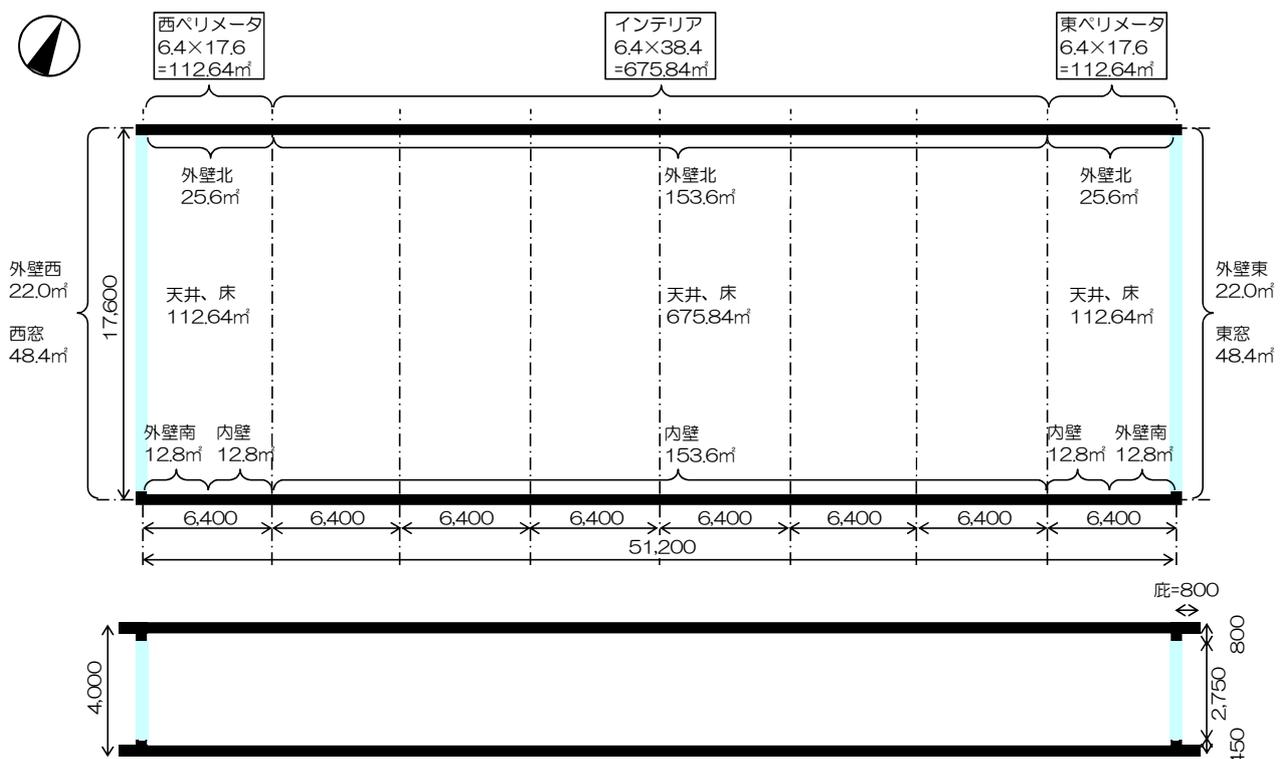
Aビルのモデル化した平面図（上）と断面図（下）
